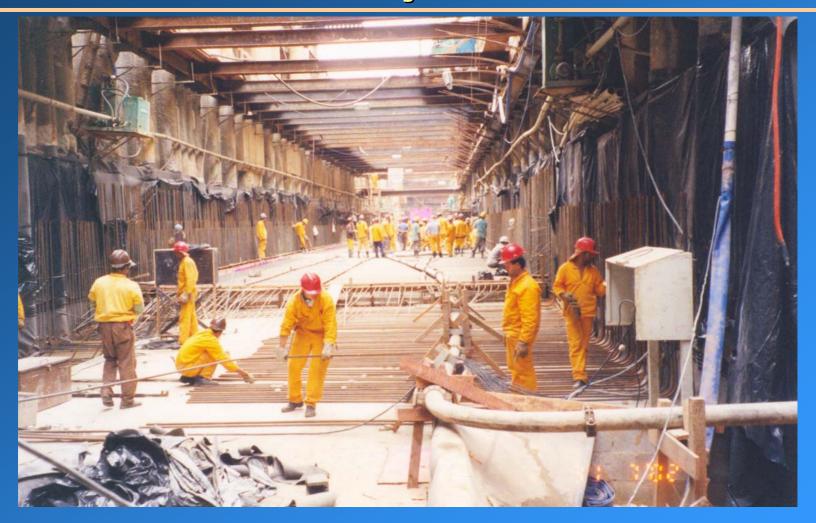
Vista do túnel com piso concretado sobre Geocomposto e lateral com concretagem parcial.
